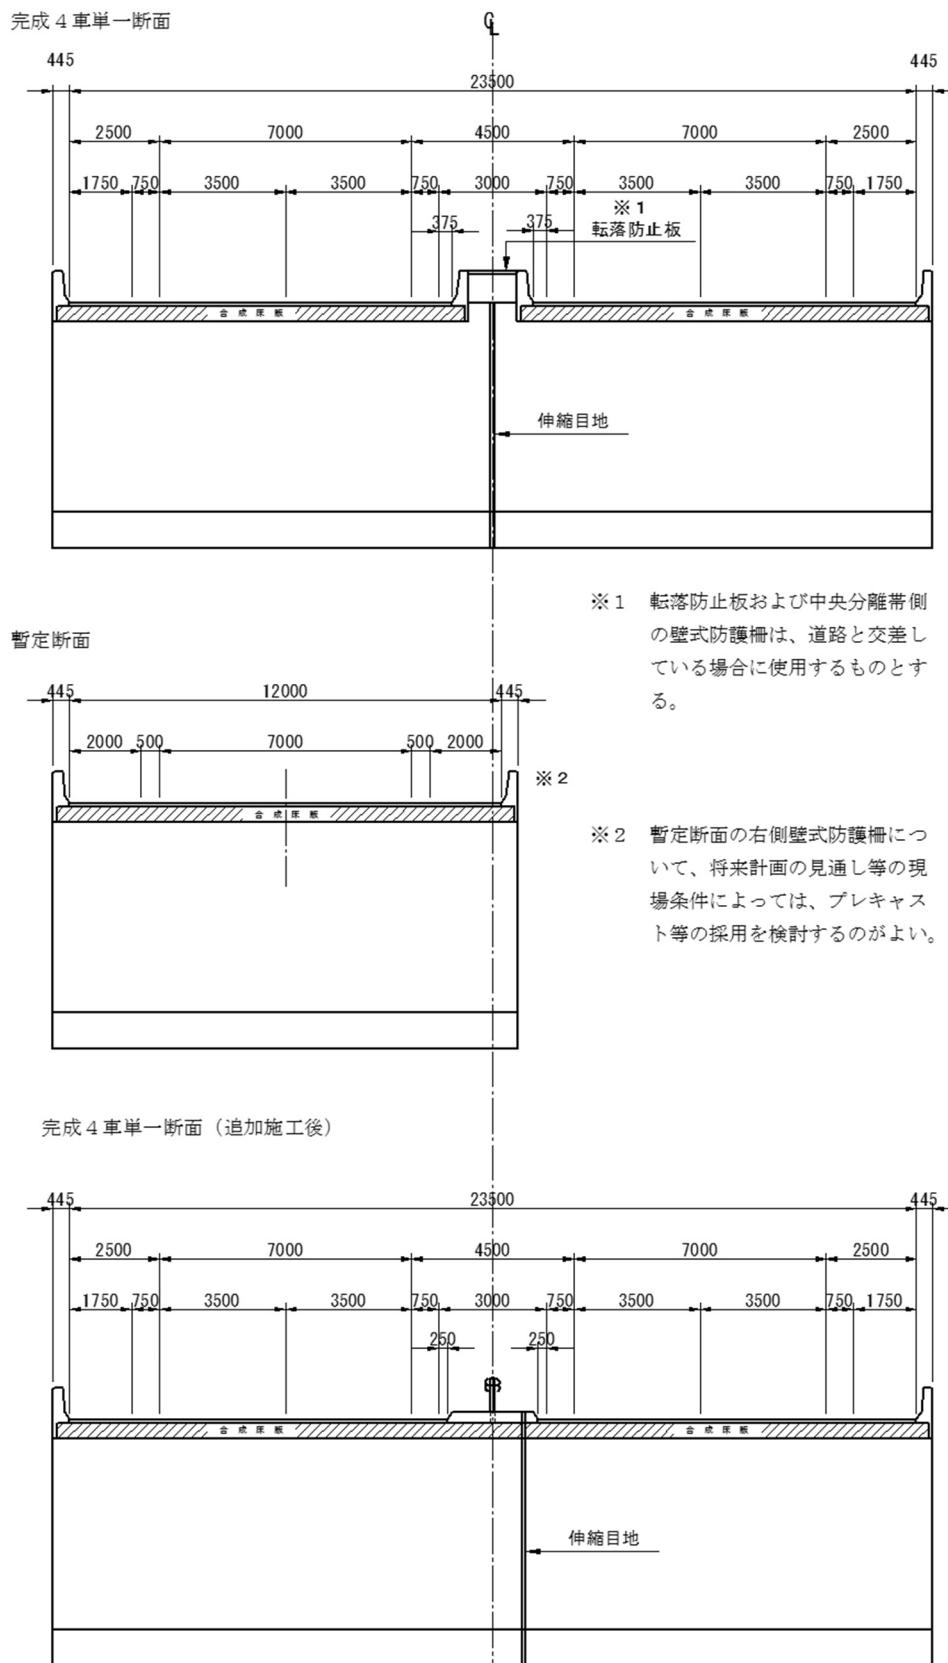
縦方向標準断面図(第1種2級B 積雪深2.0m未満の場合)
